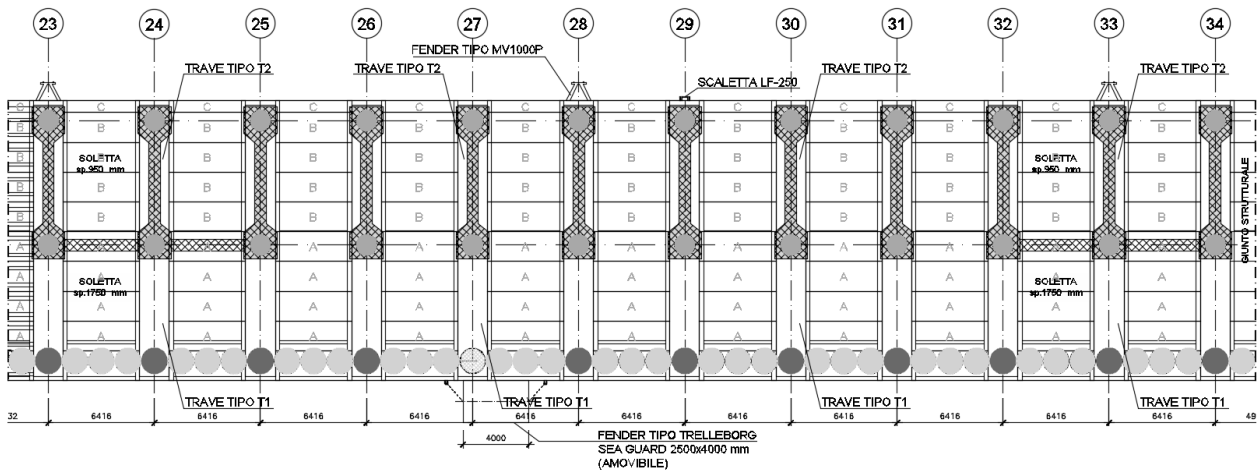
PD adeguato: Settore C – pianta fondazioni – stralcio.
